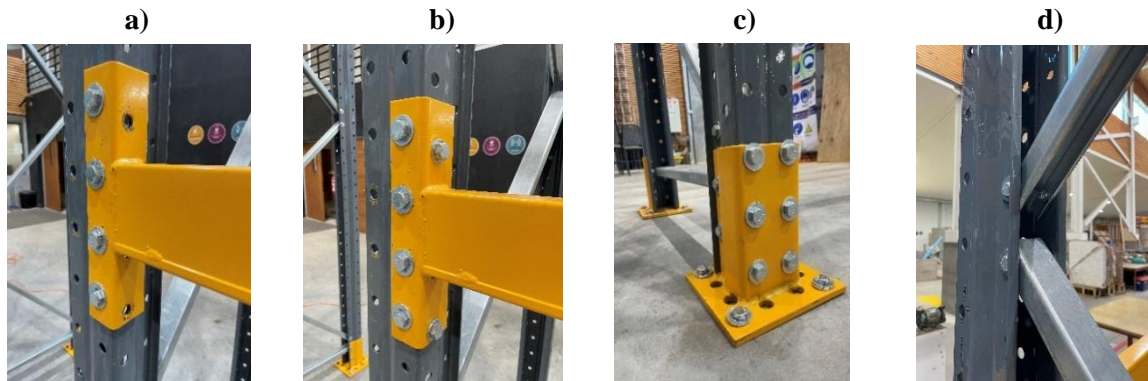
a) Conexión Viga-Columna rígida, b) Conexión Viga-columna semi rígida, c) Apoyo estructura, d) Conexión Riostras.
